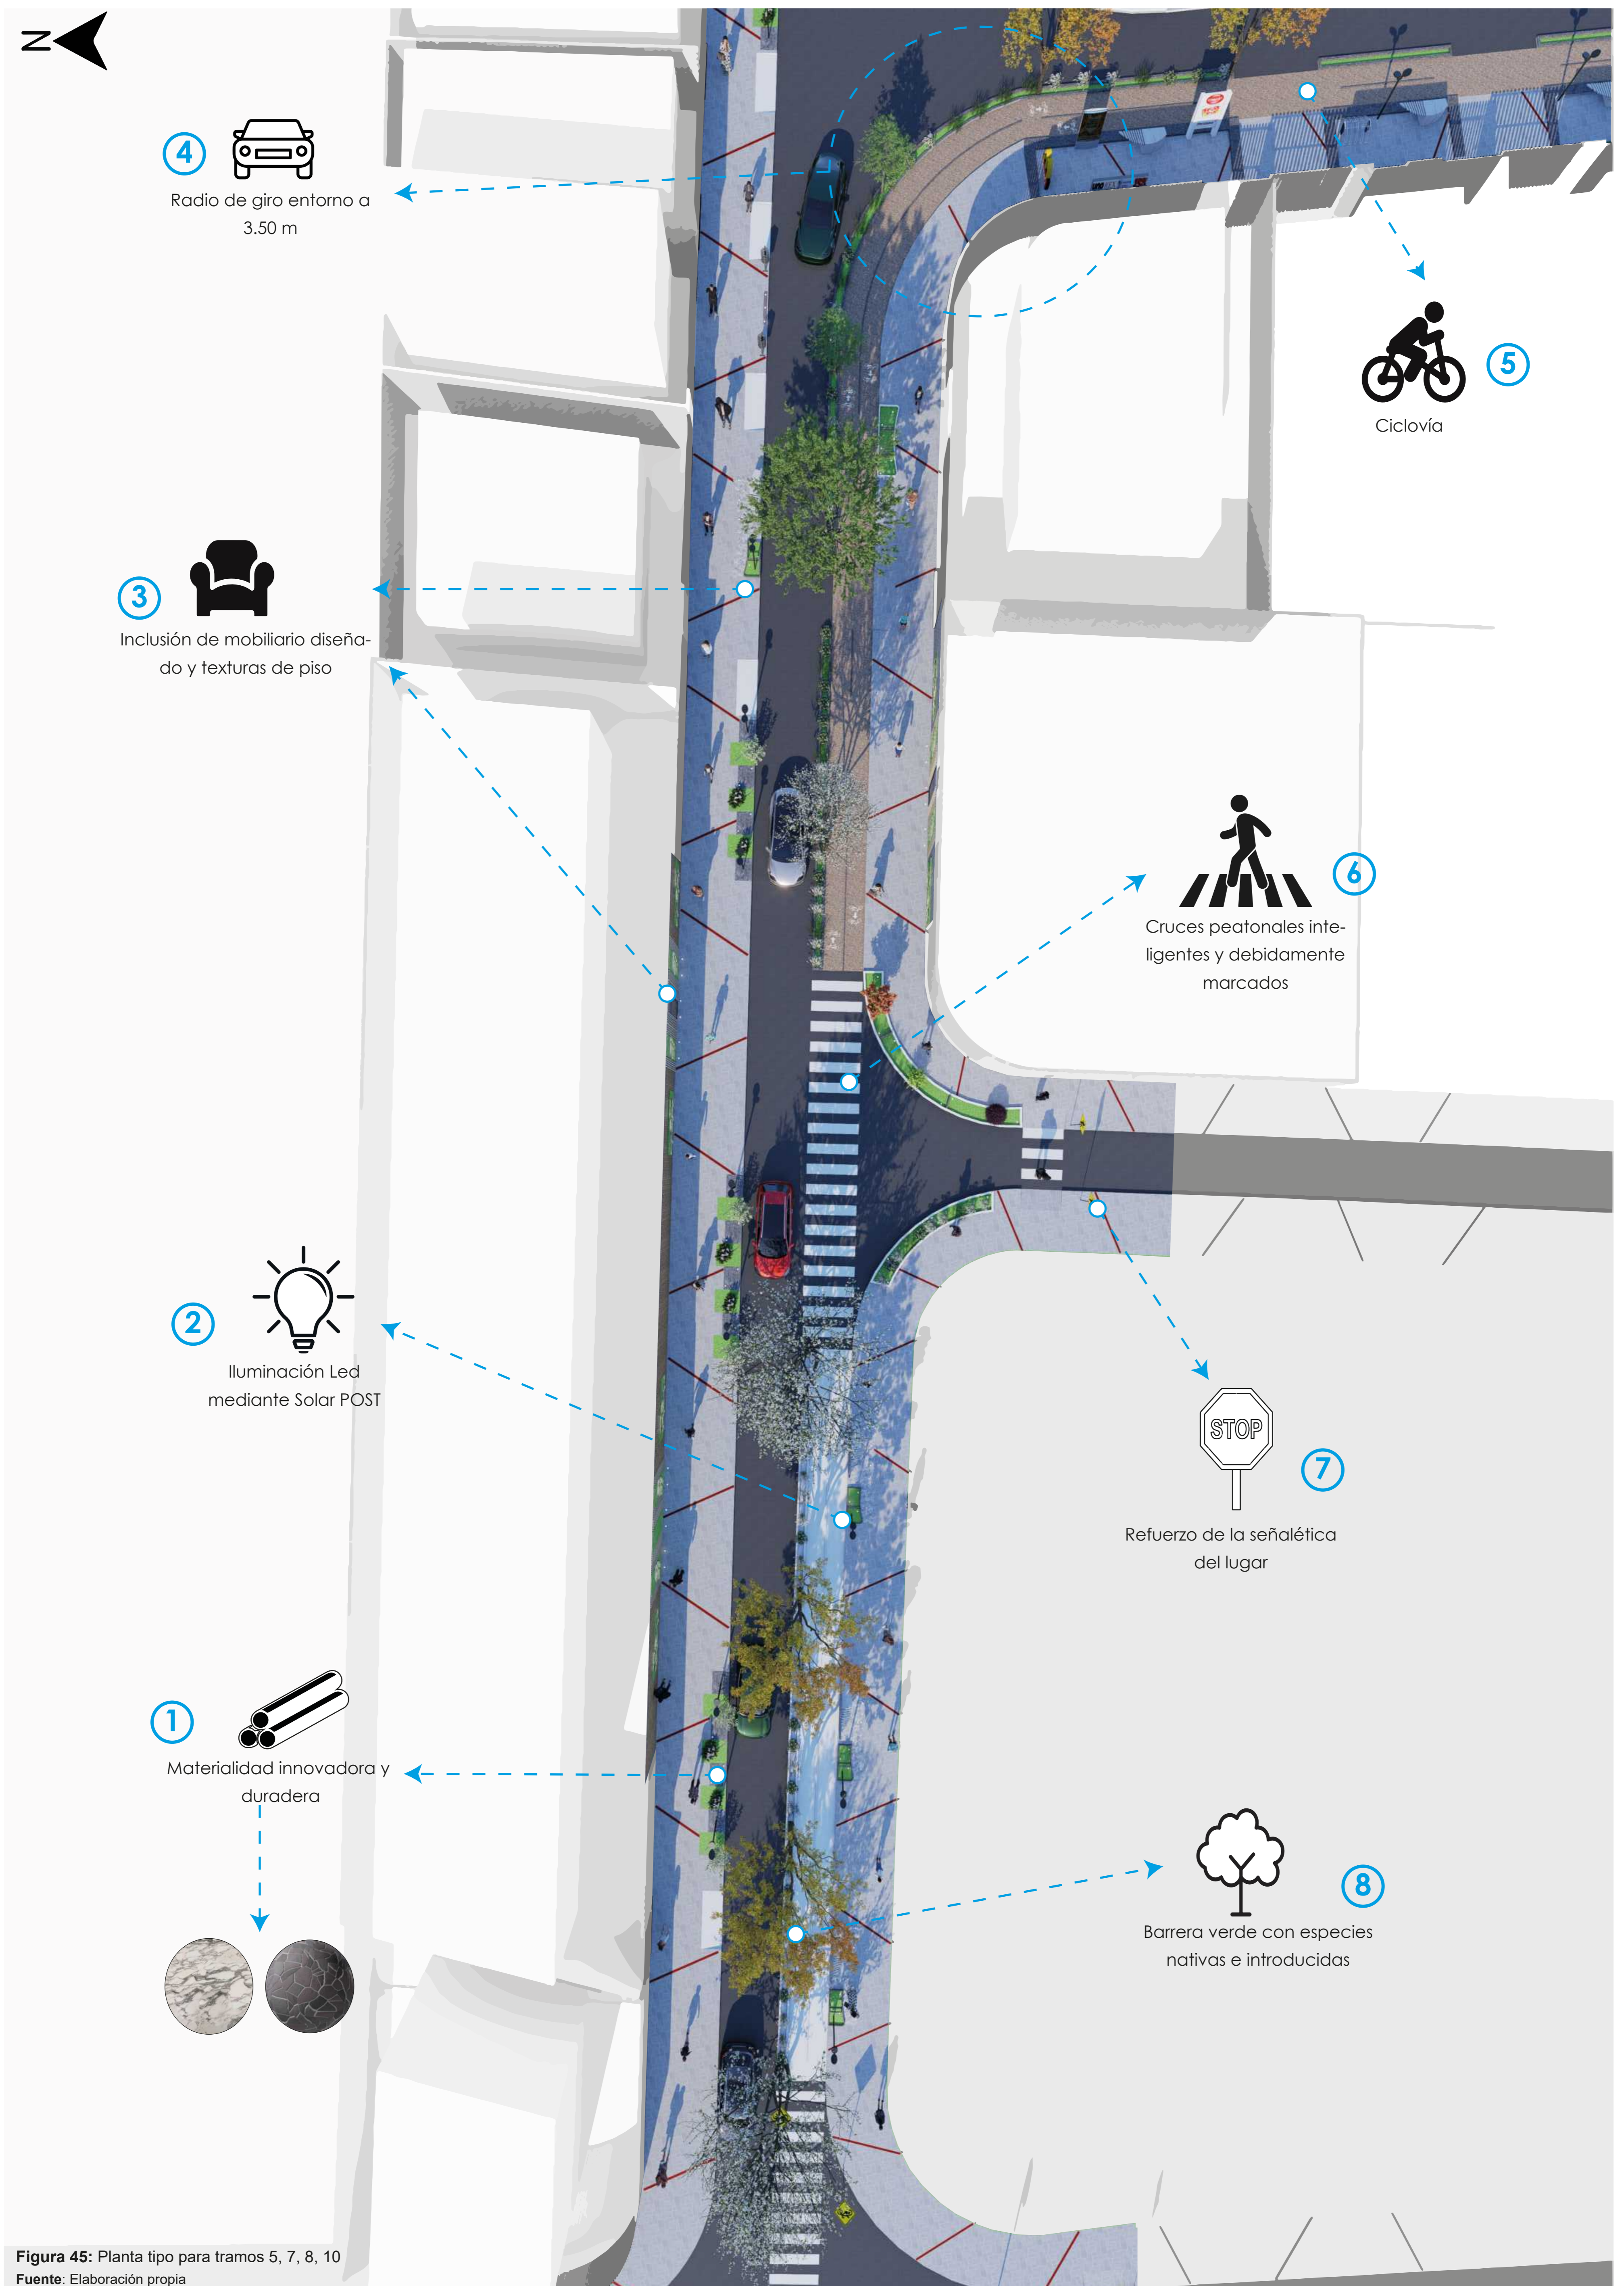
Planta tipo para tramos 5, 7, 8, 10
